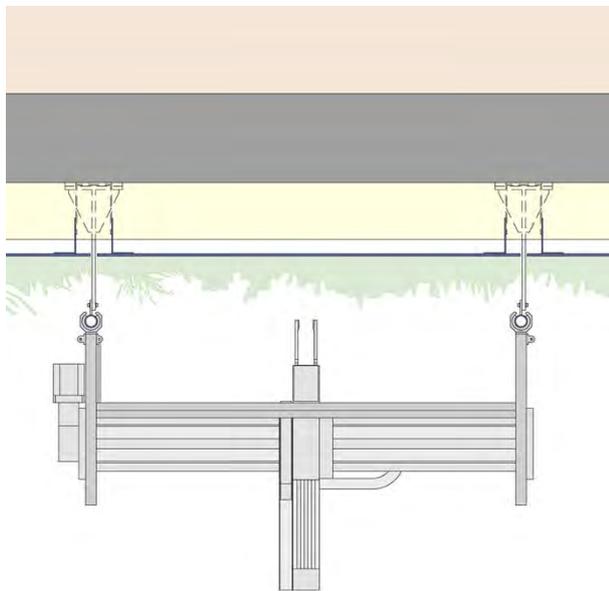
Fallstudie Grünfassade mit eingerückter Teilfläche, Begrünung wandgebundenes System (flächige Konstruktion, Ausführung VHF. Portalbauweise (Horizontalschnitt Fassade M 1:50 / Verkleinerung). Bild: Fakultät Architektur
